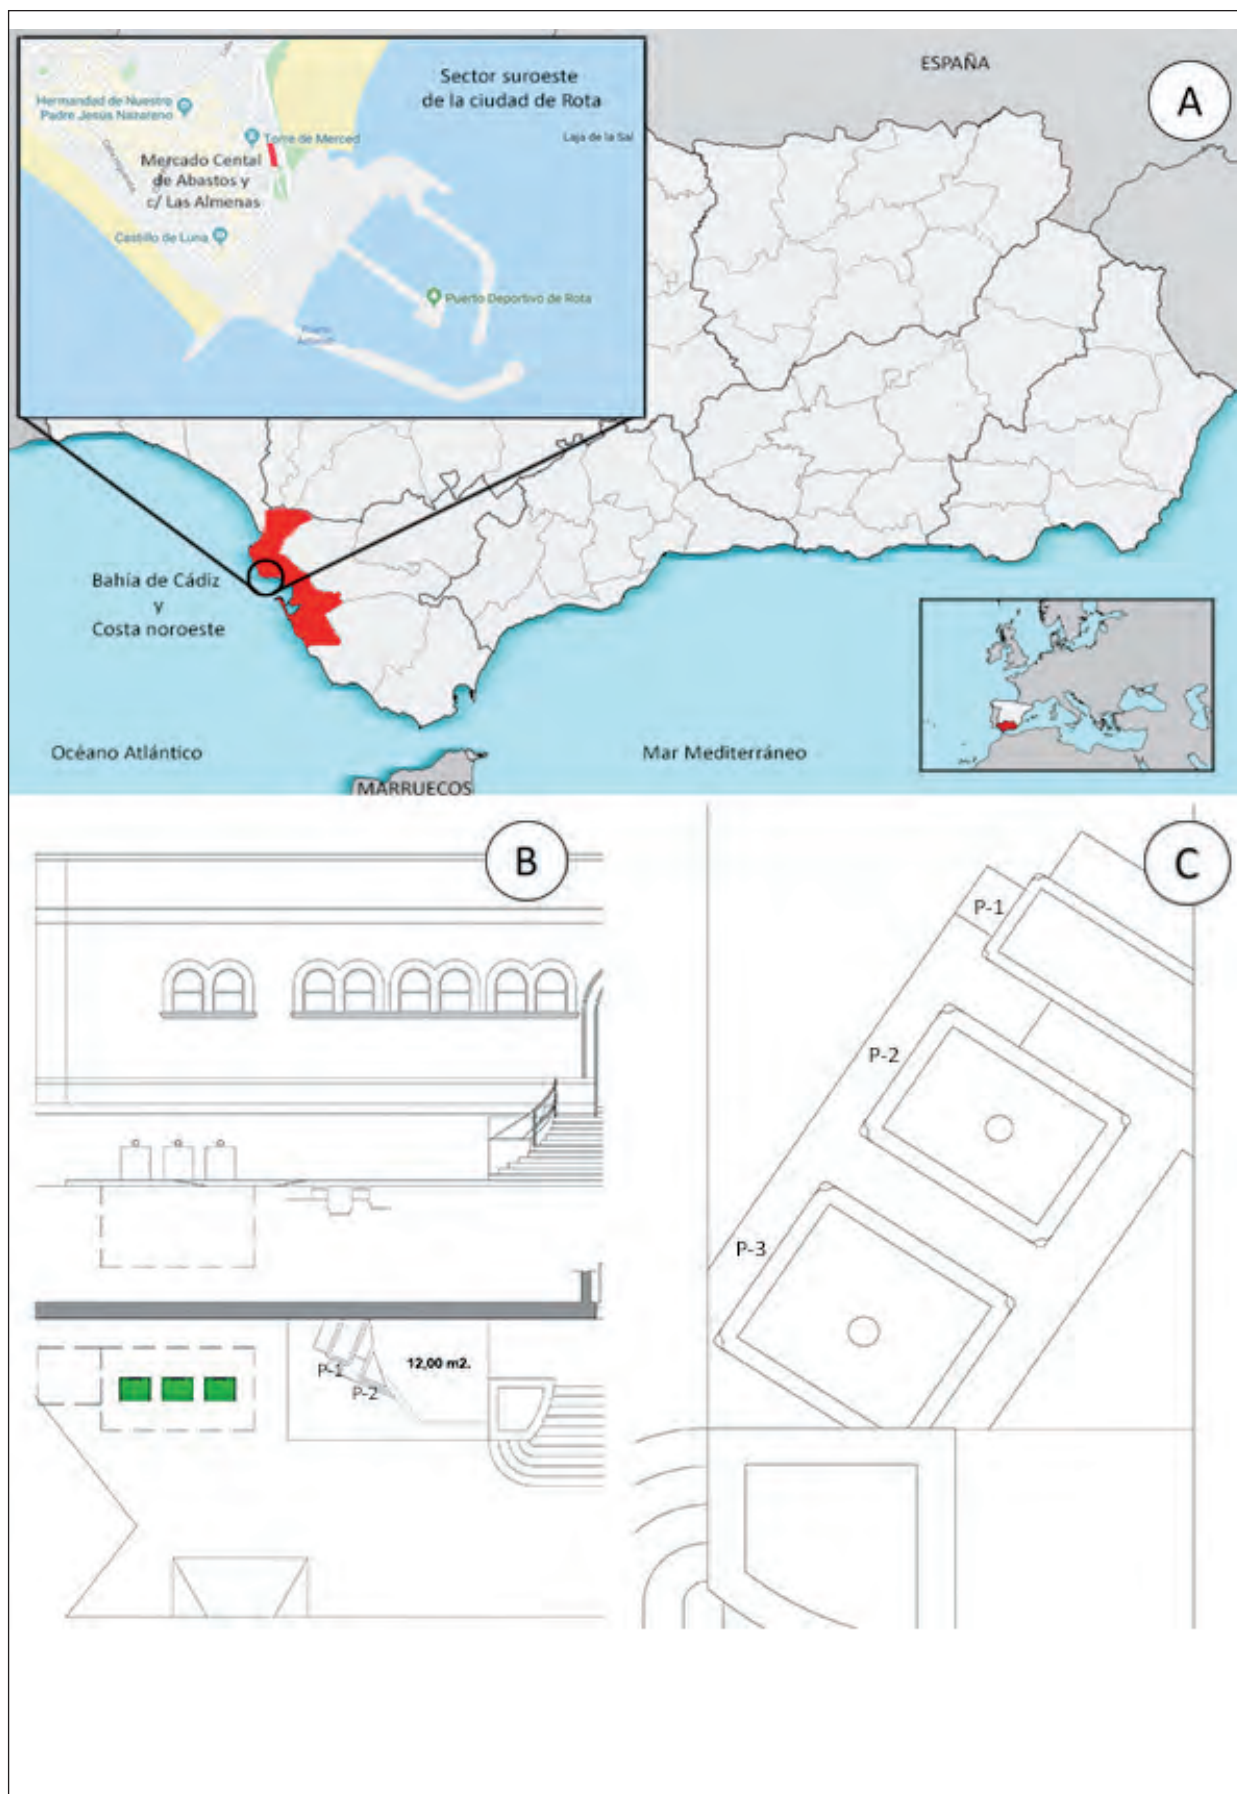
Localización de la c/Almenas – (A), con sección y planta de las estructuras romanas localizadas bajo el acceso al Mercado Central de Abastos de Rota en la primera fase (B) y con detalle de la planimetría final (C; planos del arquitecto Luis Miguel Pérez Alegre).
